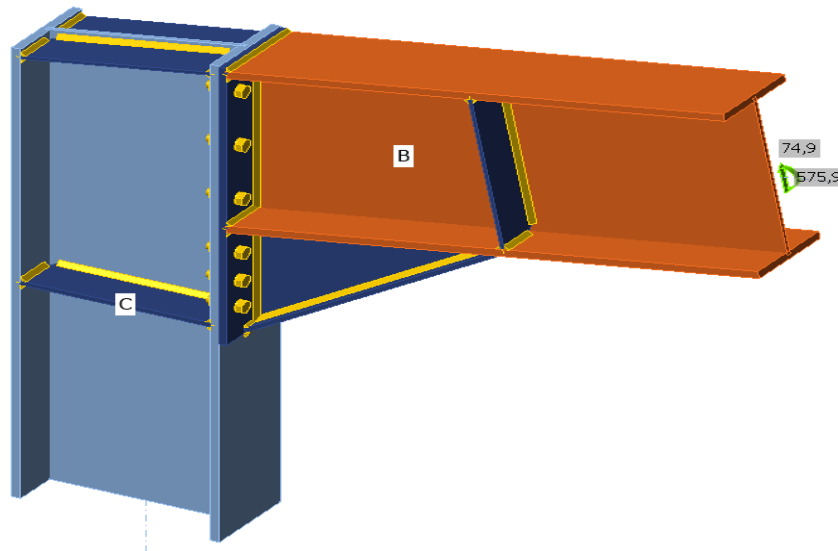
Vue d'assemblage poteau HEA600–Poutre HEA600
